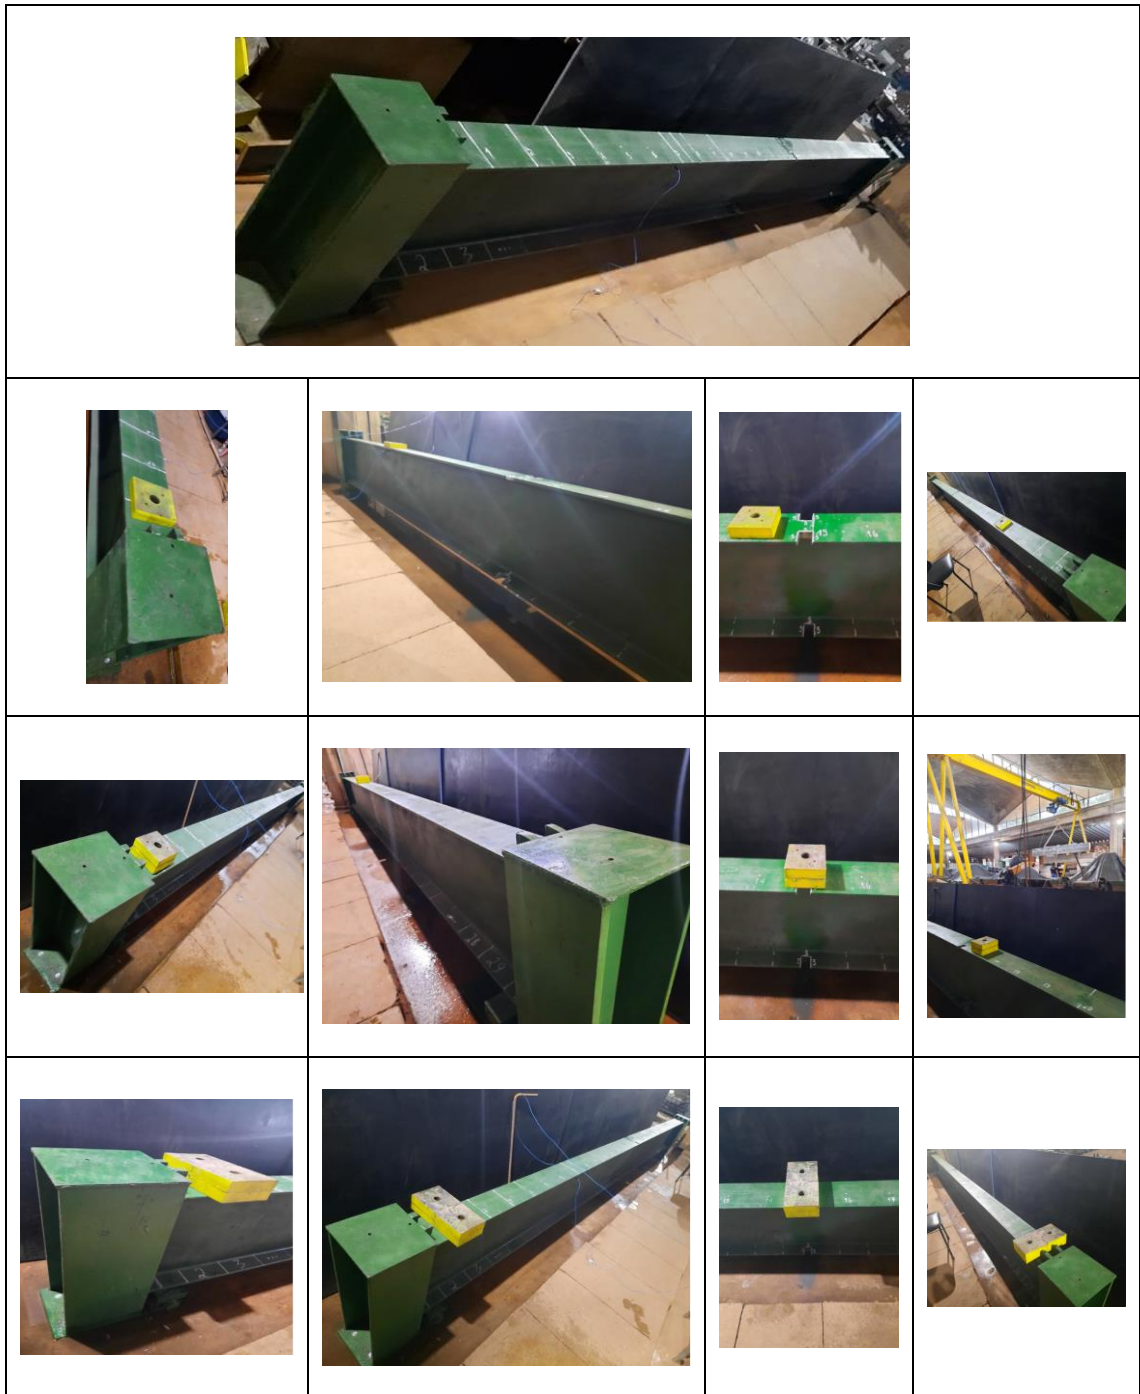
Viga Metálica IPN 500x104 Biapoiada Danificada (6 m) – Ensaio 1 Dia
